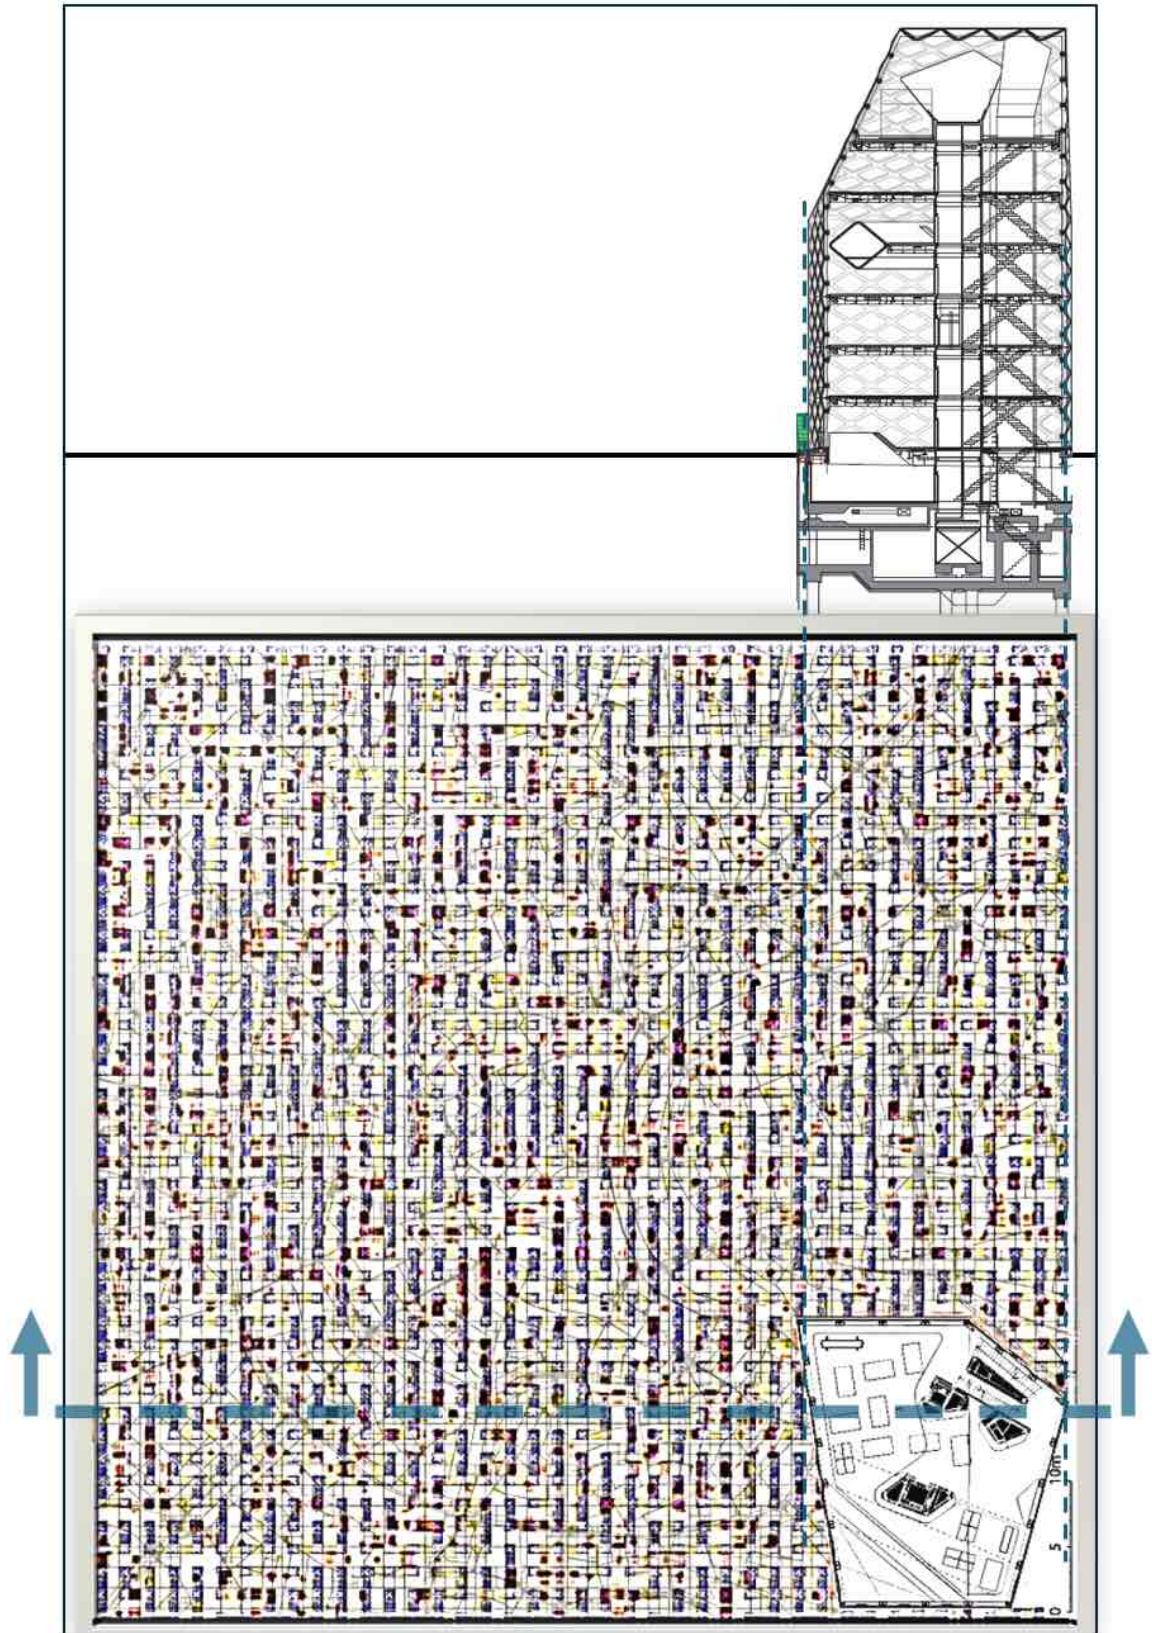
vista zenitale (planimetrica) e una sezione verticale in giacitura Sudest - Nordovest dell'area di progetto con indicato l'edificio di referenza.
